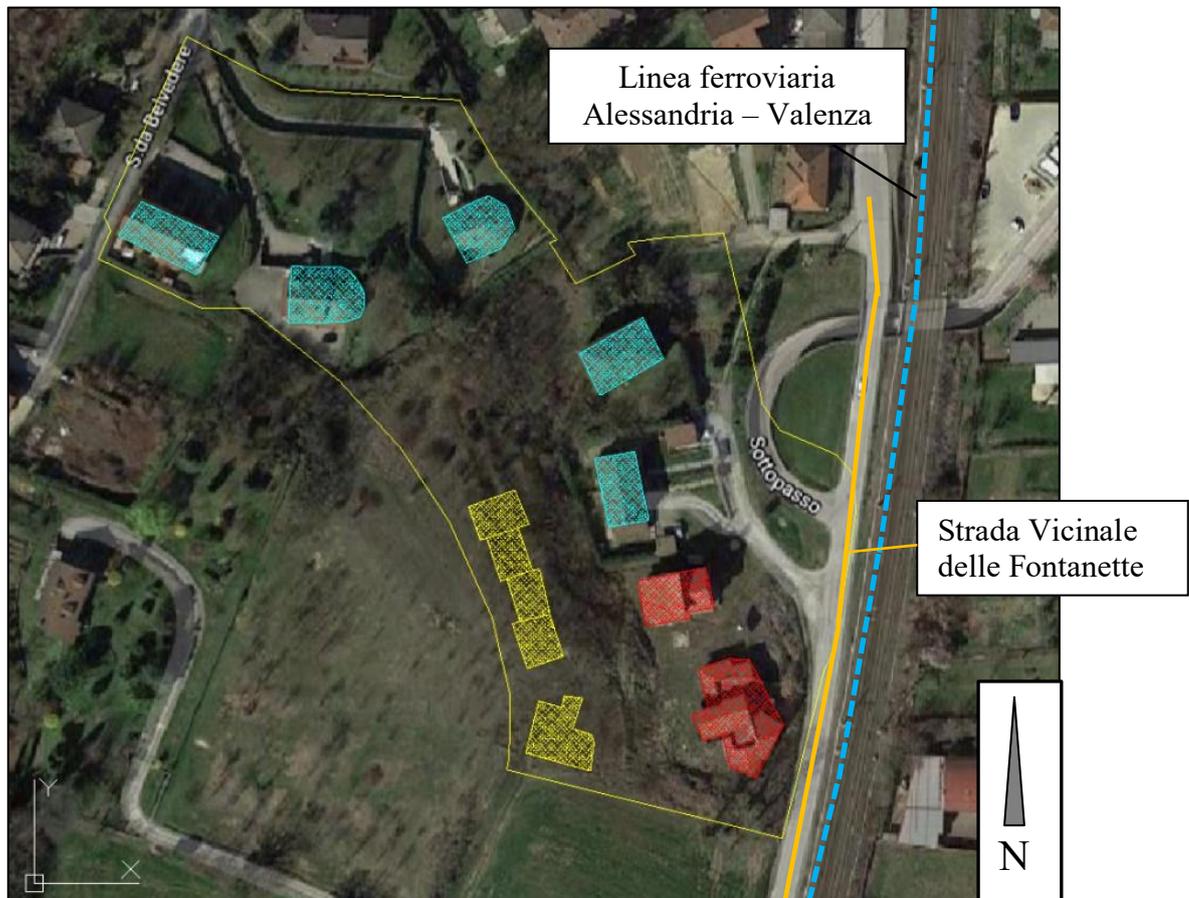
Vista dall'alto dell'area oggetto di intervento
